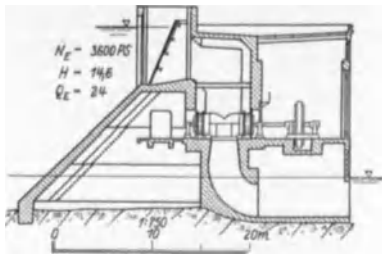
Cedar Falls, Dammwerk mit eingebautem Krafthaus.
